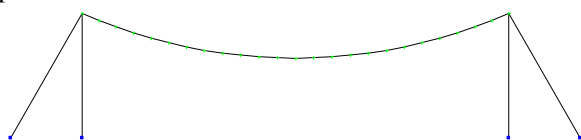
Расчетная схема гибкой нити с опорными конструкциями
